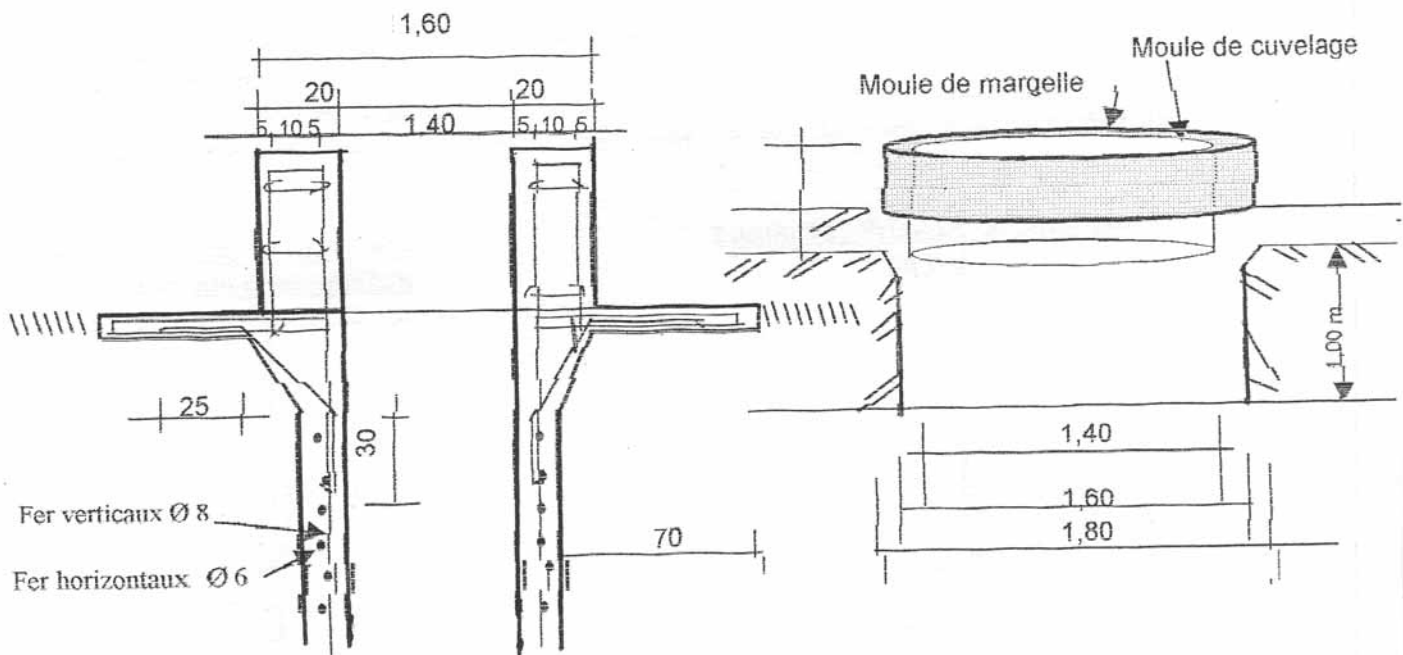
Vue en plan du ferrailage de la margelle et ancrage de surface
